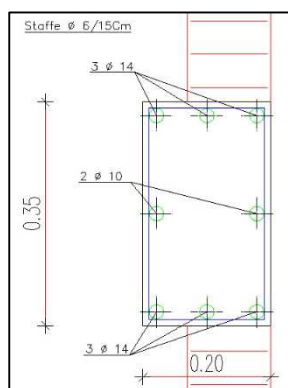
rappresentazione grafica delle armature longitudinali delle travi.
